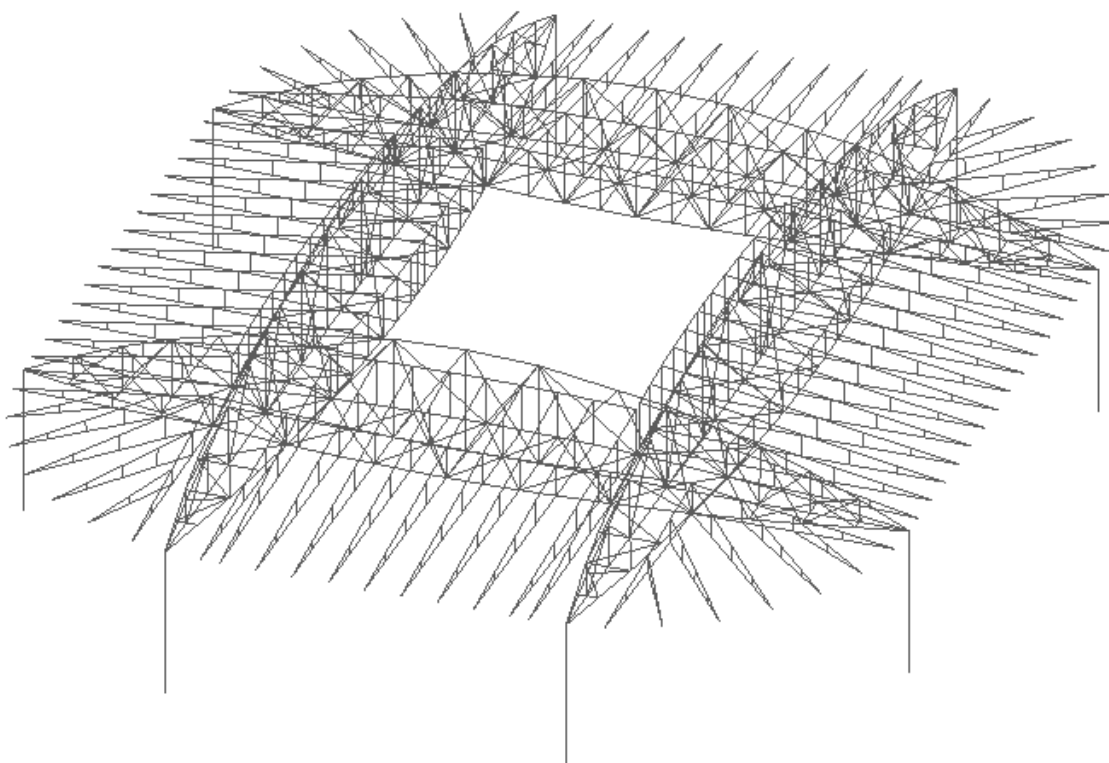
Расчетная схема 2-го варианта
